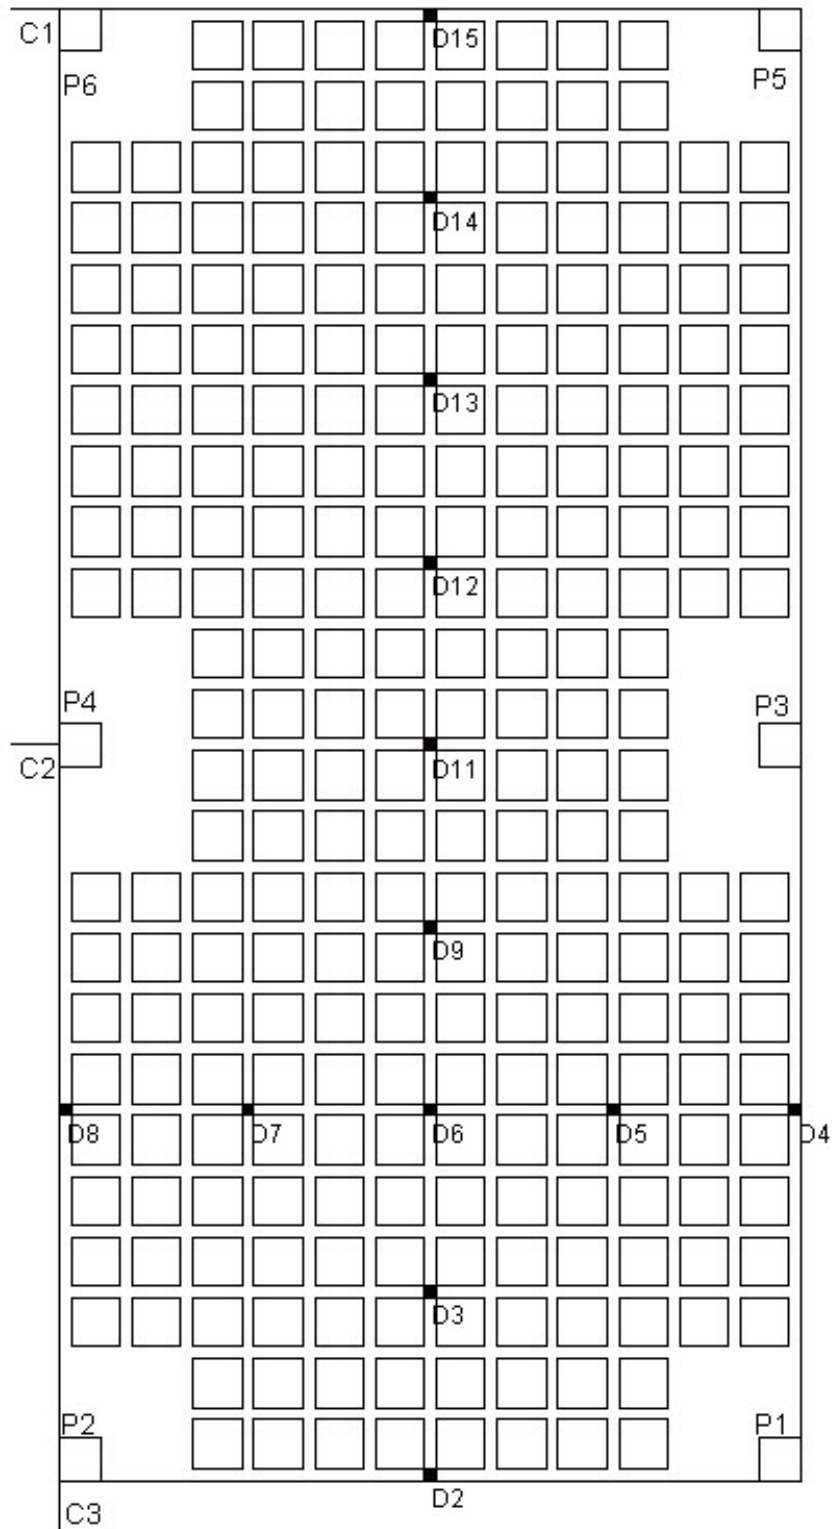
Vista inferior da laje com o posicionamento dos deflectômetros (D) e clinômetros (C)
